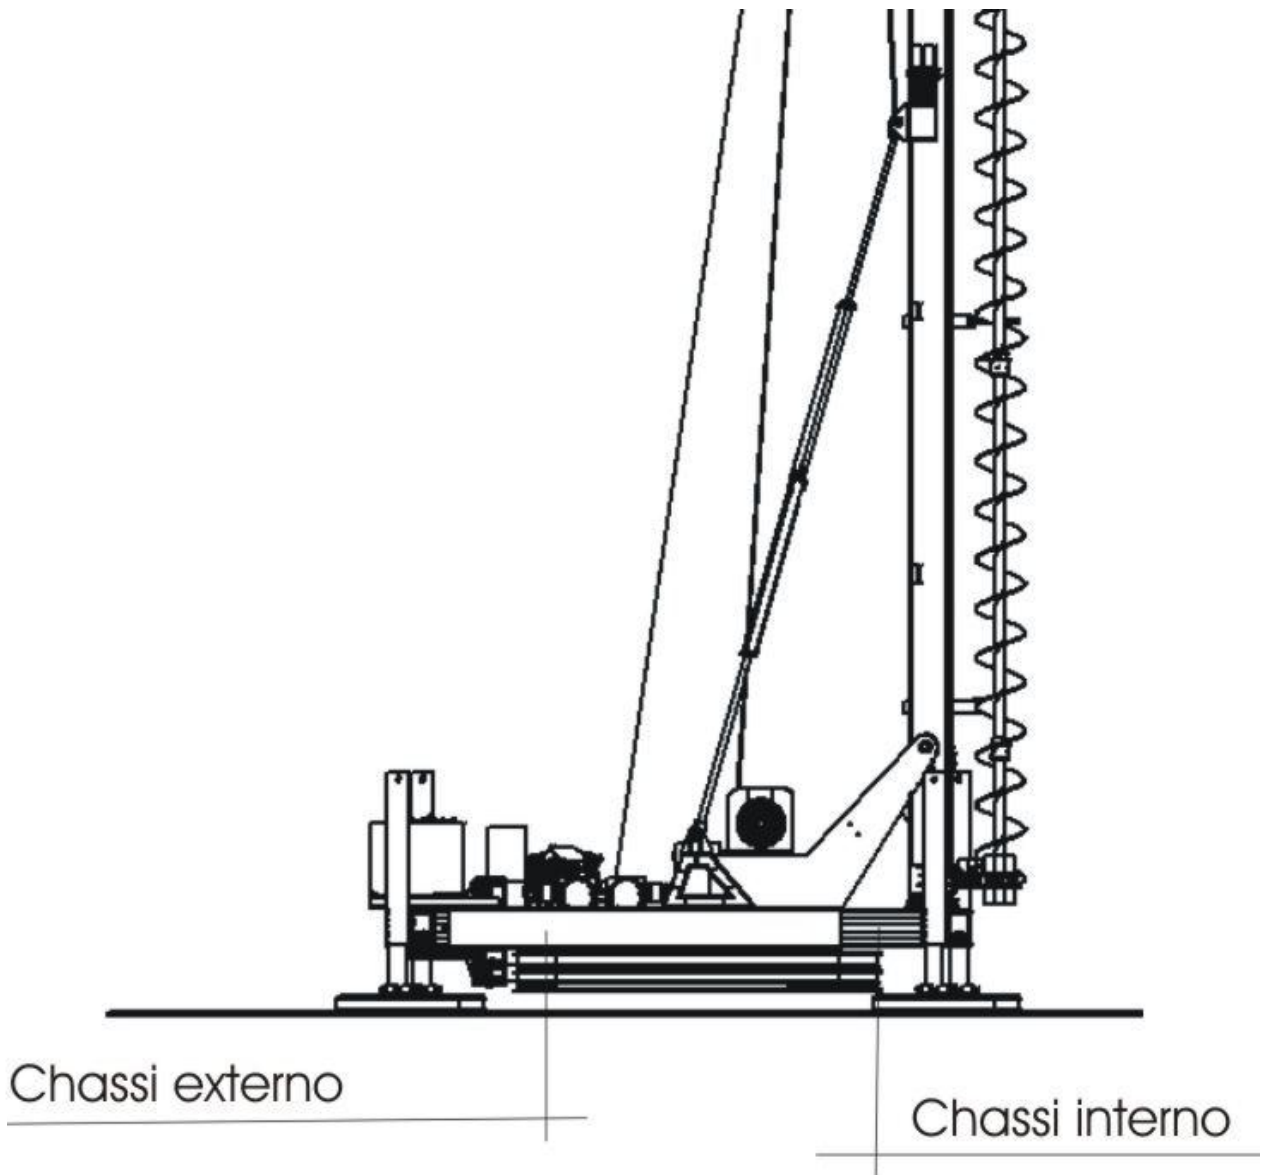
Chassi interno posicionado à direita do chassi externo.
